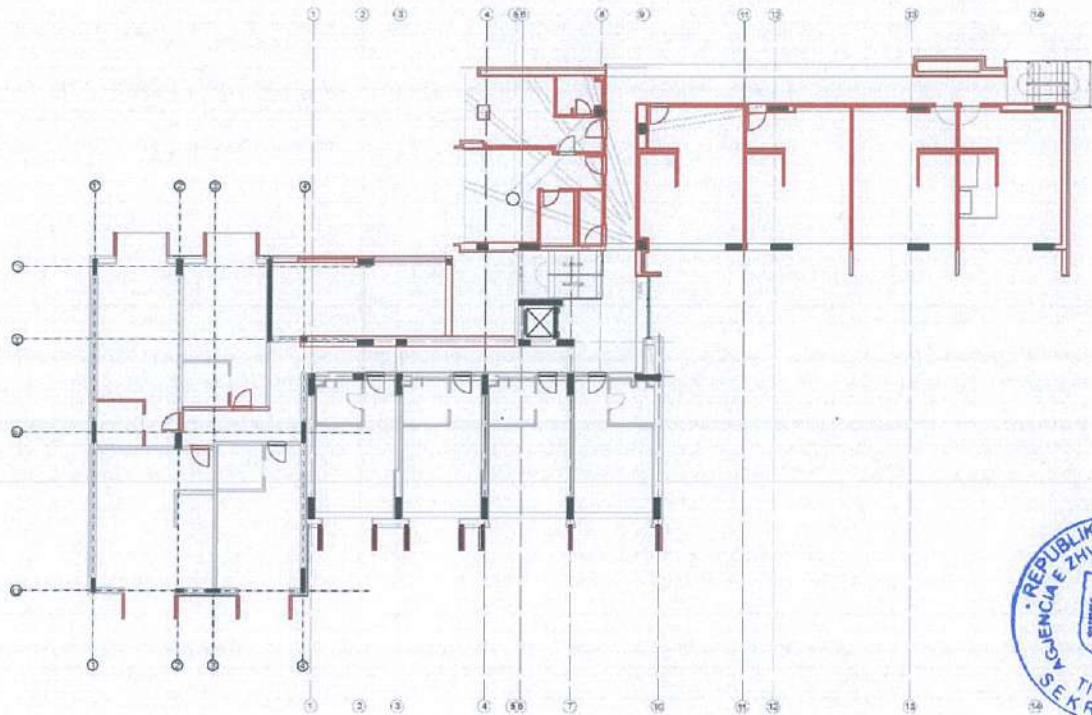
Planimetria e katit të parë dhe të të katit tip, Ndërhyrje në prishje
